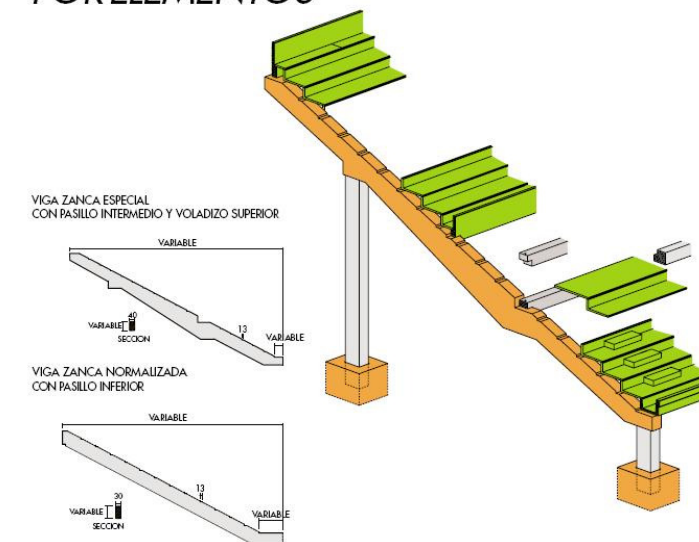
B2 –Detalle de montaje de una grada prefabricada.
